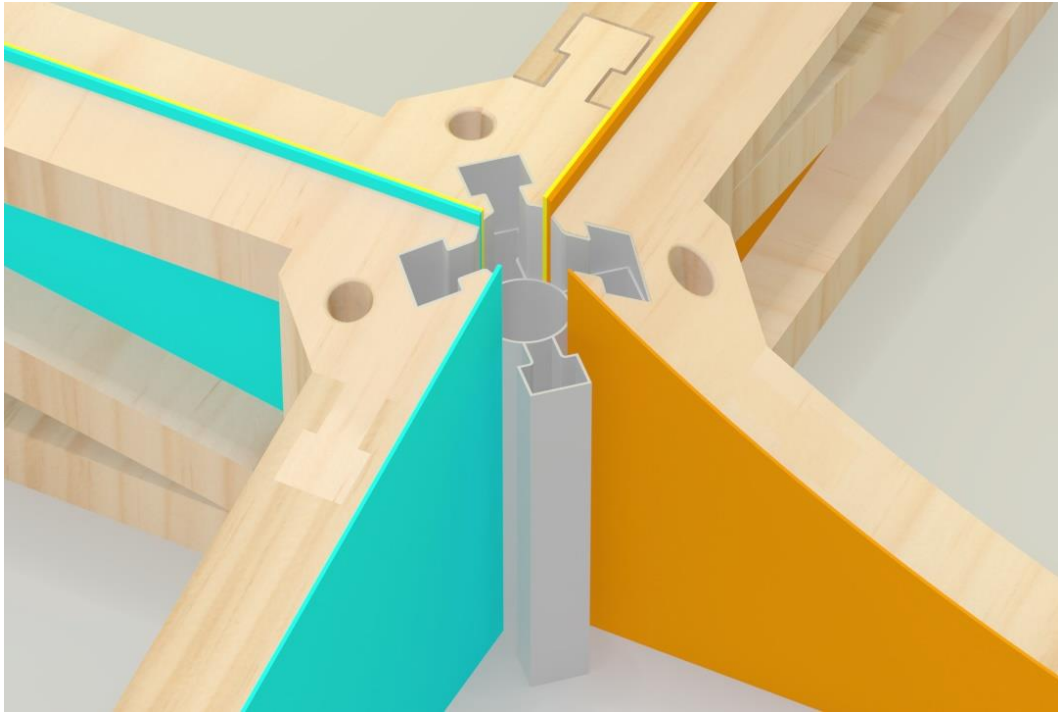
Detalle de unión de 3 módulos sin cubierta
